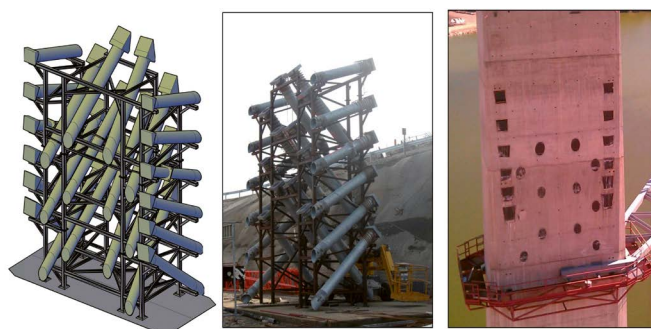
Estructura auxiliar para el posicionamiento de las tuberías en las pilas P6 y P15.
